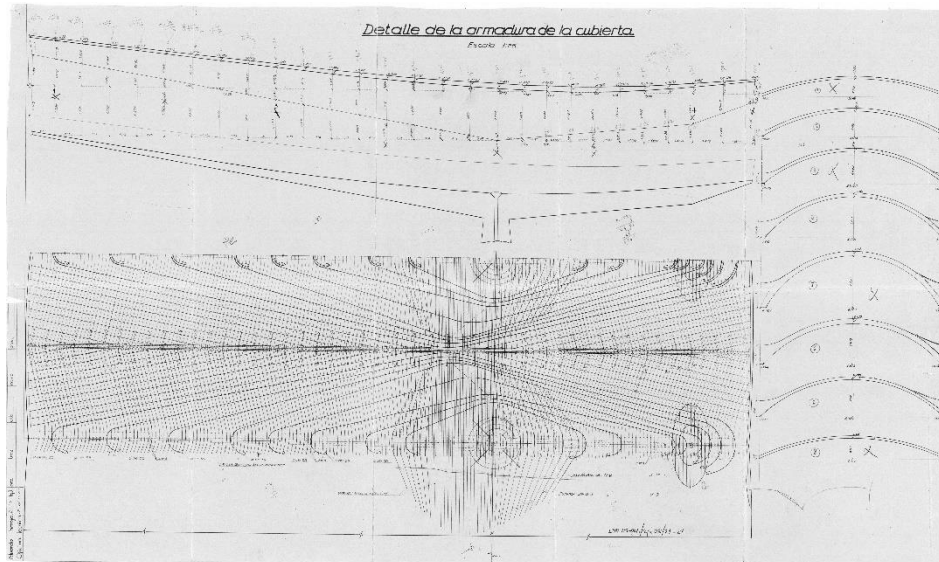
Detalle de la armadura de la cubierta. (Fuente: Plano nº 246.228 del AET)
